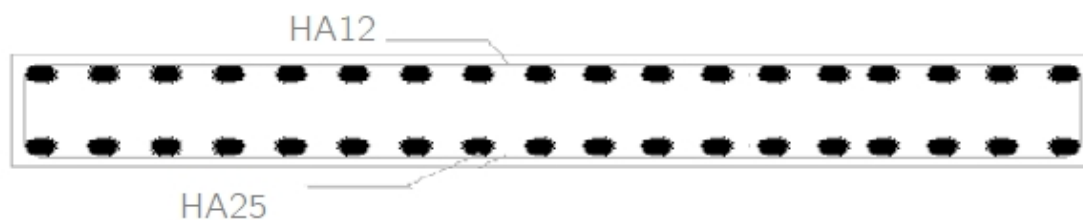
Schéma de ferrailage de la dalle de transition
